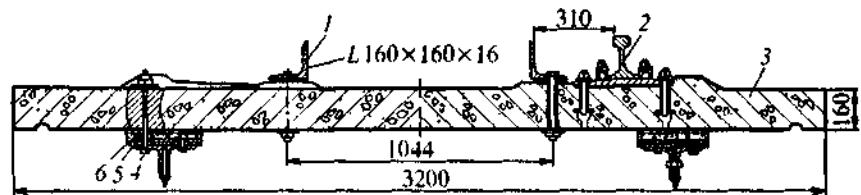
Безбалластное мостовое полотно на железобетонных плитах: 1 — контр уголок, 2 — рельс, 3 — железобетонная плита; 4 — высокопрочная шпилька крепления плиты, 5 — цементно-песчаная заливка (монтажная деревянная прокладка омоноличена); 6 — арматурная сетка
